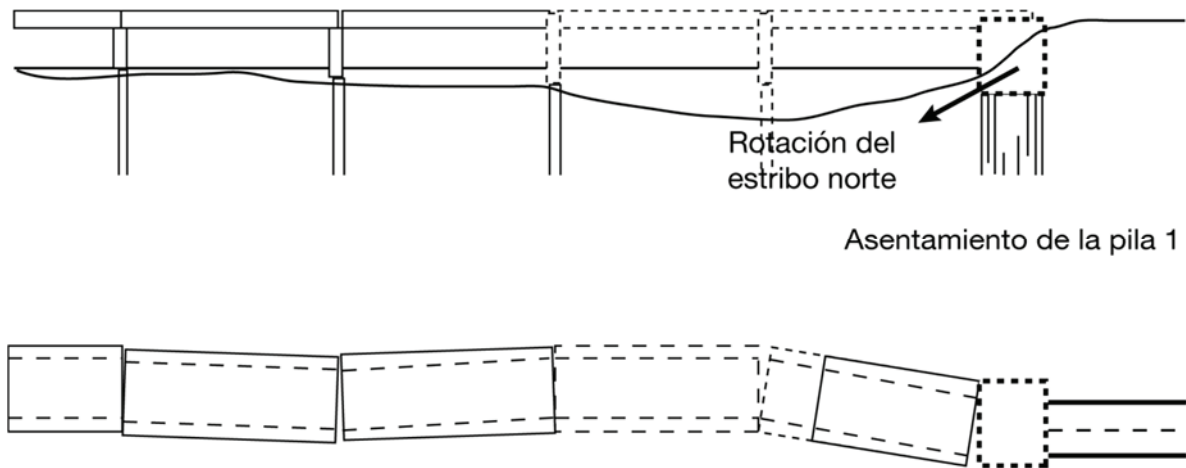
Elevación y planta del Puente Lo Gallardo, cercano a la zona epicentral. Obsérvese la rotación del estribo Norte y el asentamiento en la pila 1, ambos origen del estado final del tablero y de los daños observados. (Fuente: Monge, 1986)
